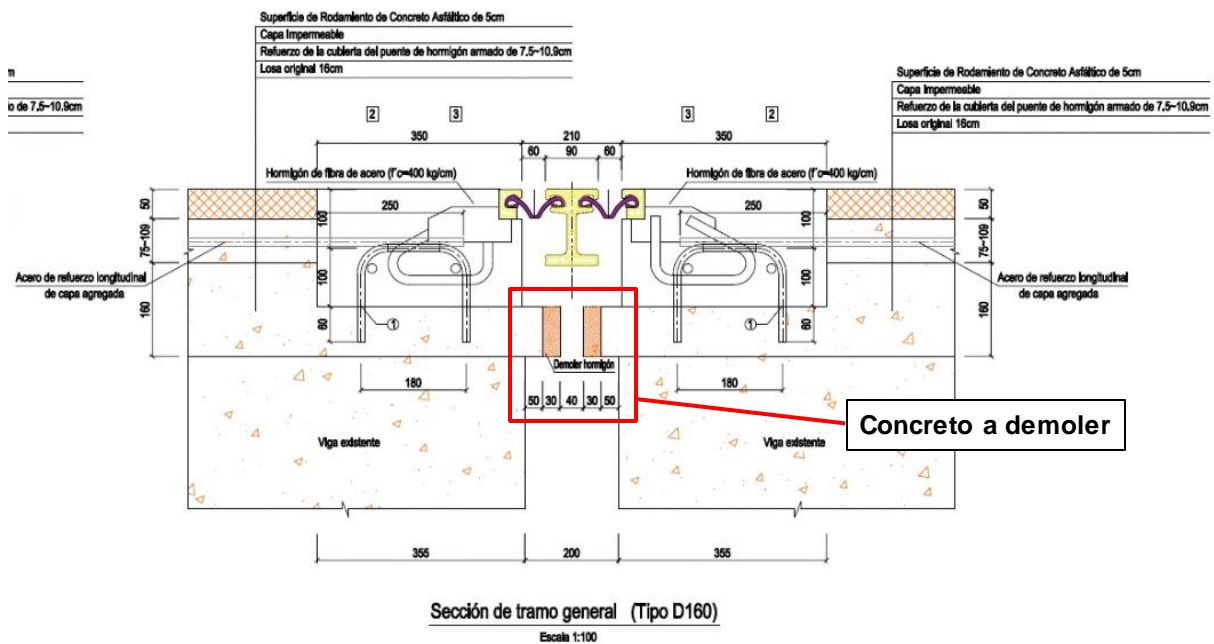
Detalle constructivo de la nueva junta de expansión sobre la Pila 2 según se muestra en los planos de rehabilitación del puente existente sobre el río Destierro.
